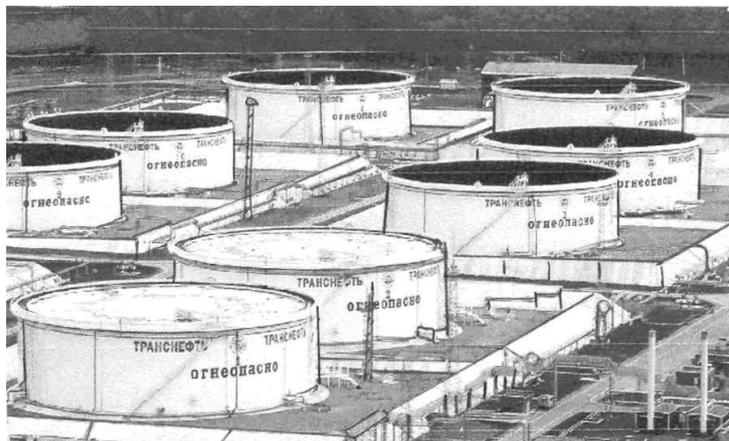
Резервуарный парк с вертикальными цилиндрическими резервуарами
